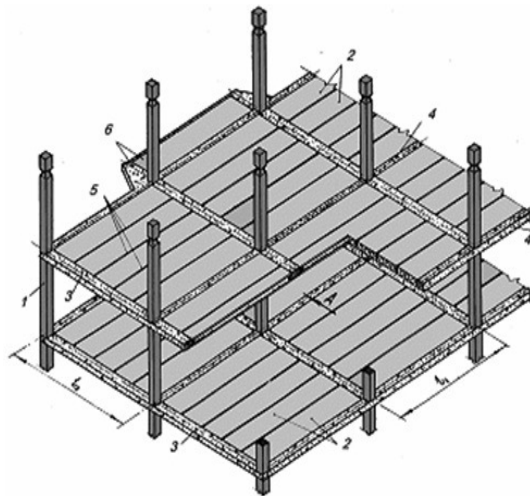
Каркас «Аркас»: 1 – колони з наскрізними прорізами для пропуску несучого та в'язевих ригелів; 2 – збірні багатопустотні плити; 3 – монолітні несучі ригелі; 4 – монолітні в'язеві ригелі; 5 – міжплитні шви омонолічування; 6 – консолі для балконів та еркерів
